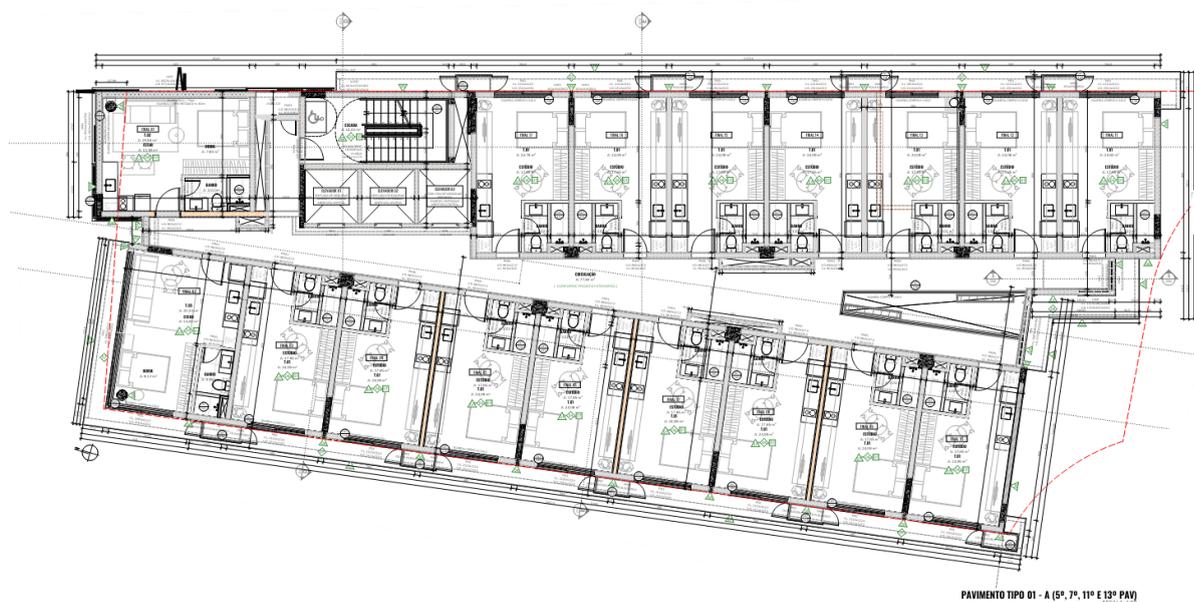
Planta Baixa Arquitetônica Pavimento Tipo
